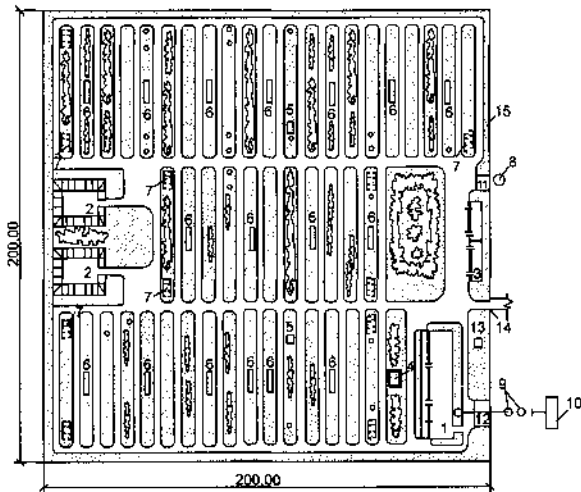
Схема генерального плана пчеловодческой фермы на 1200 пчелиных семей (ТП 808-05-18.86):
